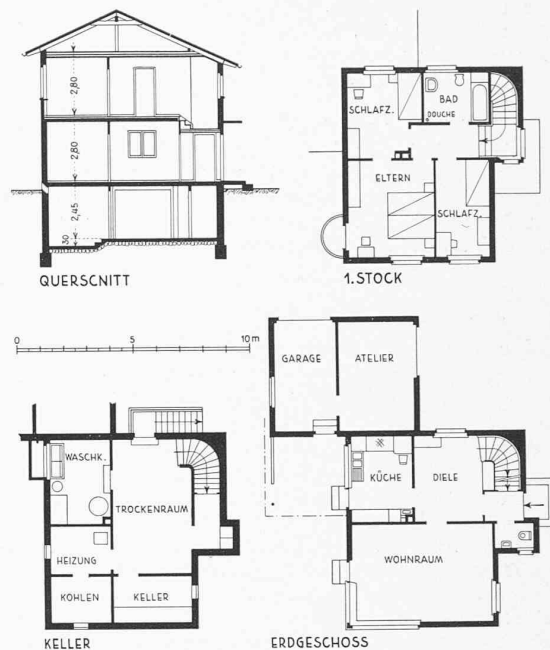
Einfamilienhaus A. Huber an der Säumerstrasse, Rüschlikon. — Arch. Hans Roth, Kilchberg. — Abb. 20. Grundrisse und Schnitt. 1:300.
